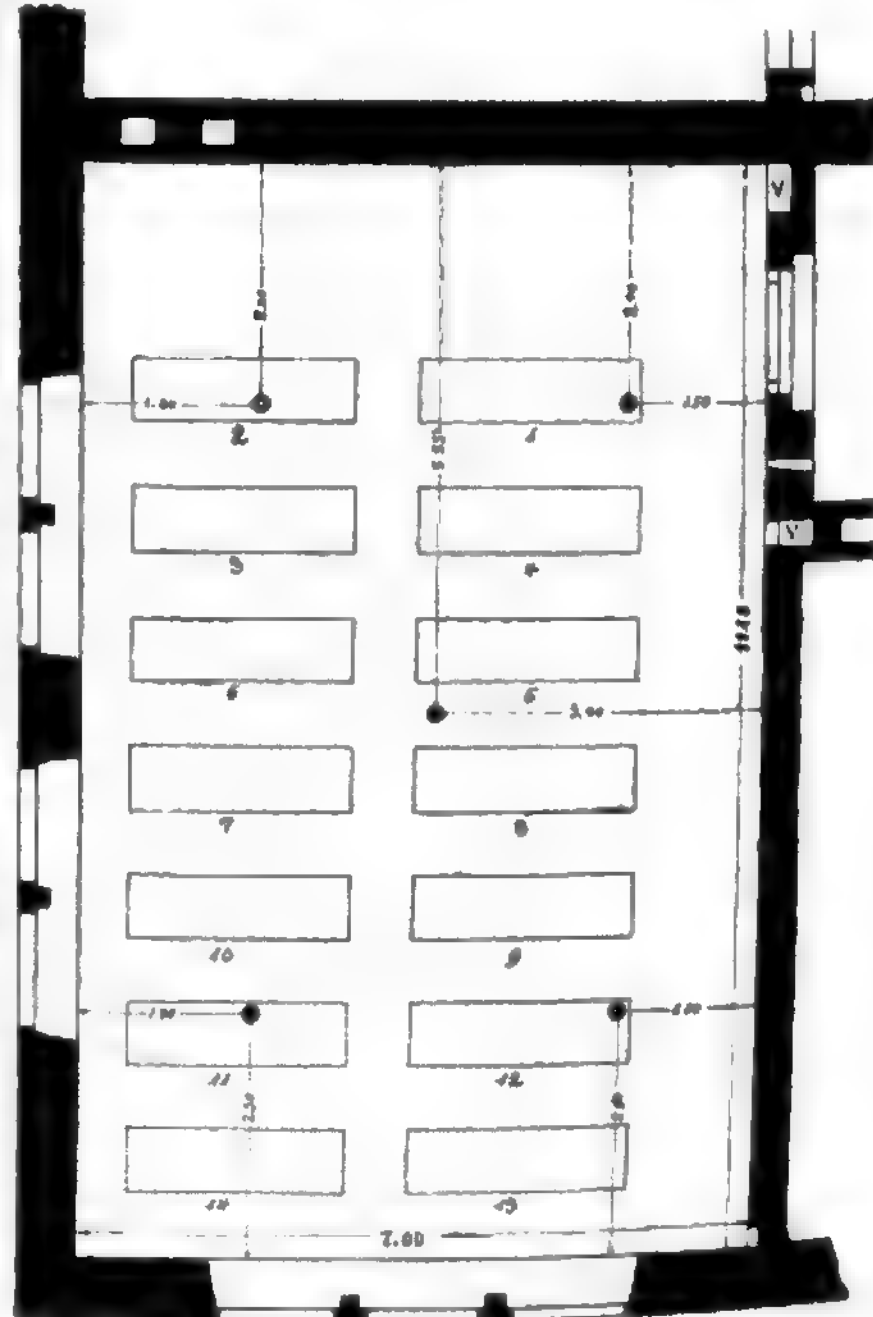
Saal II. Grundriss. Anordnung der Lampen und Messpunkte.
